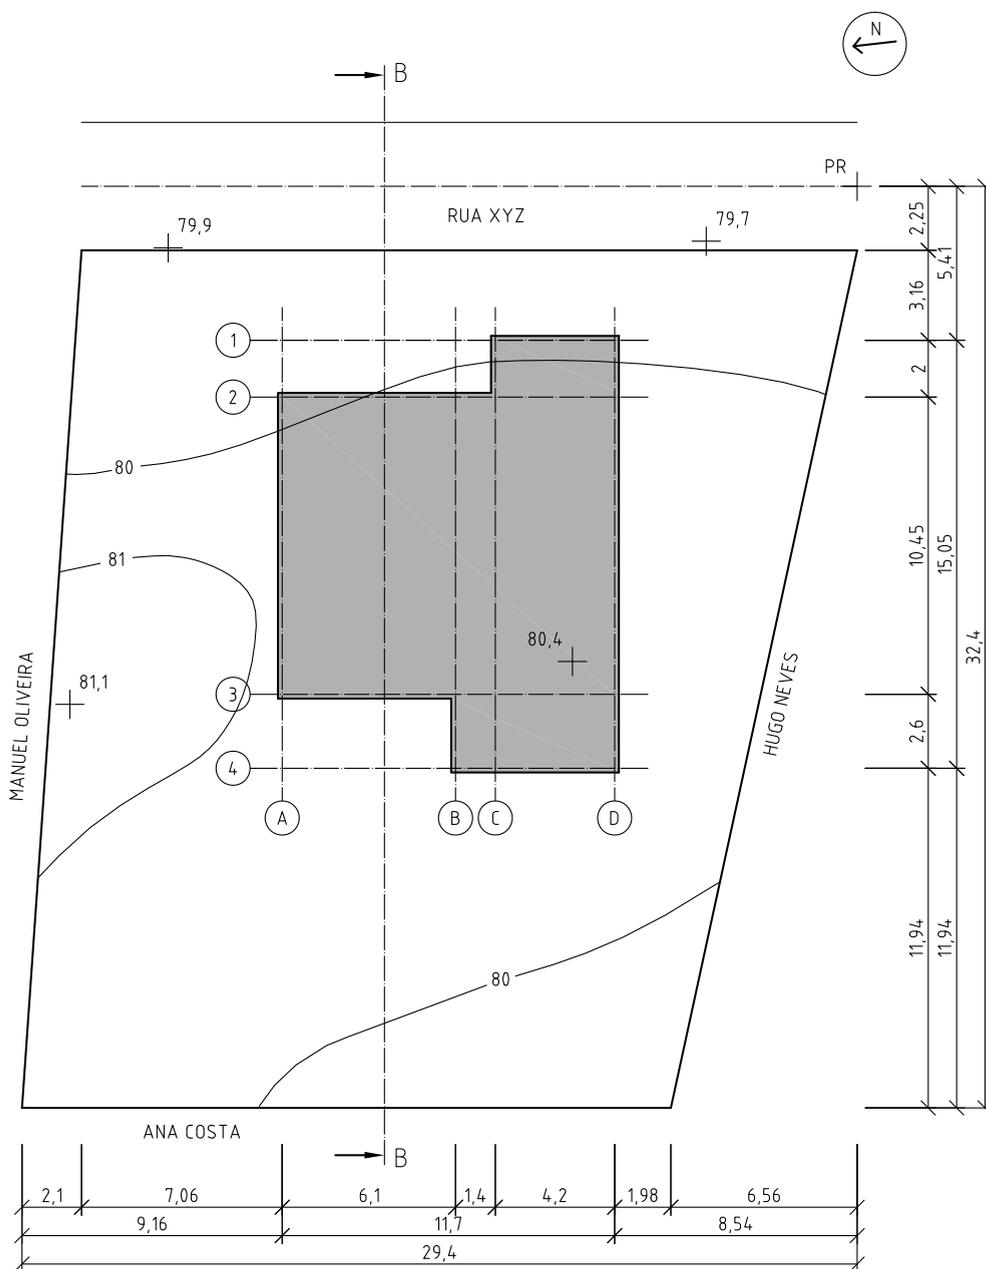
Desenhos de conjunto: planta de implantação com a malha de projeto.
